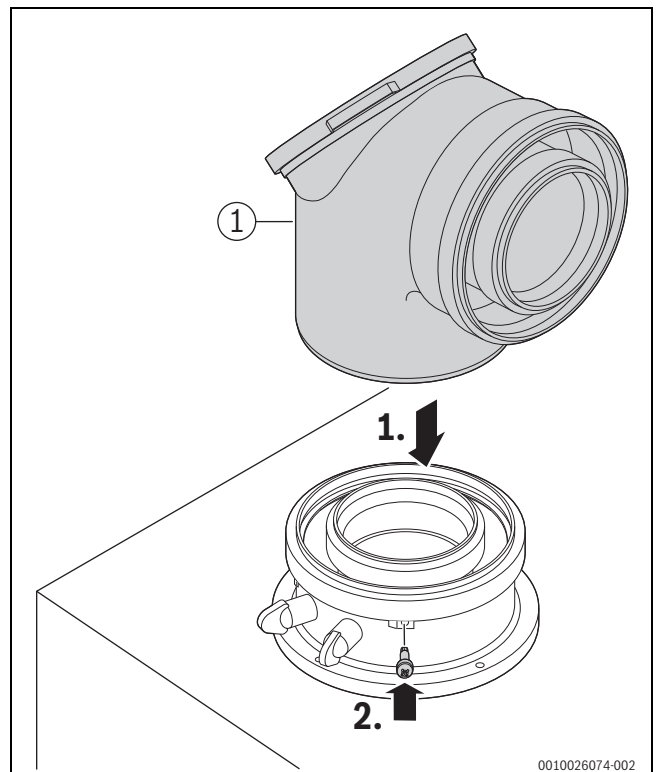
Abgaszubehör einsetzen und mit Schraube sichern
